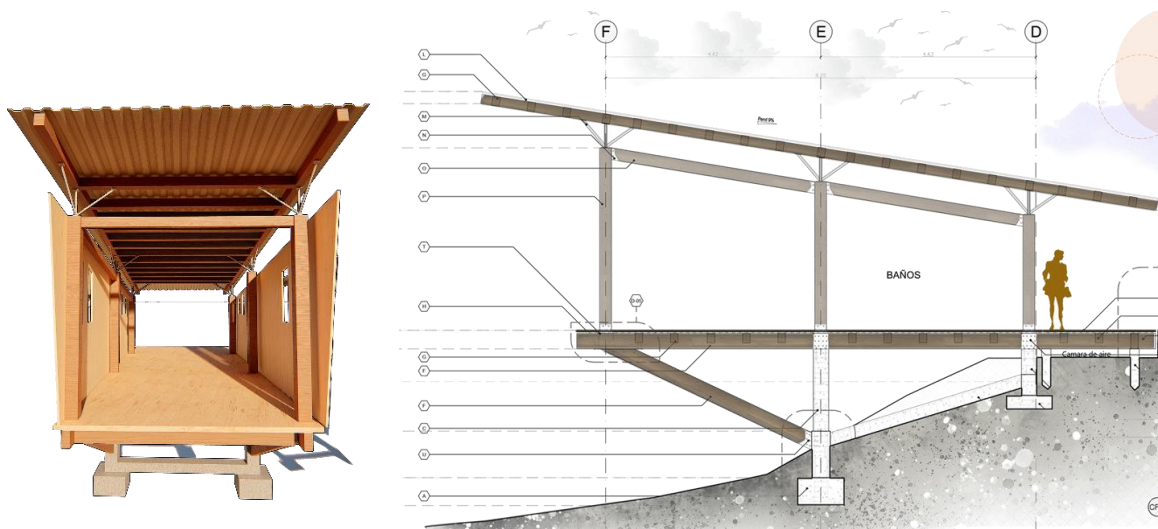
Corte sistema estructural de zonas húmedas. Elaboración propia.
